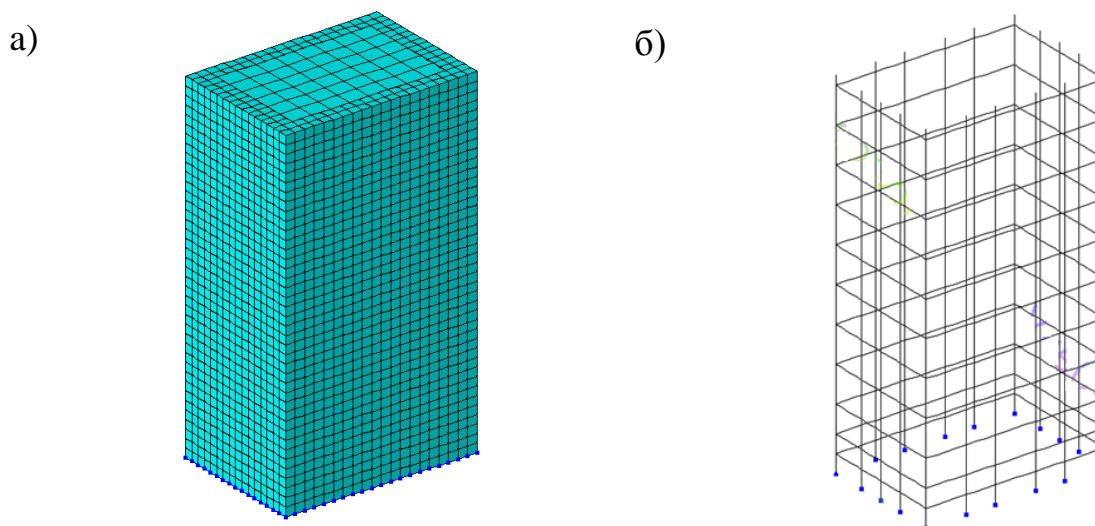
Общий вид (а) и схема армирования (б) расчетной модели столбчатого фундамента МНЛЗ.
